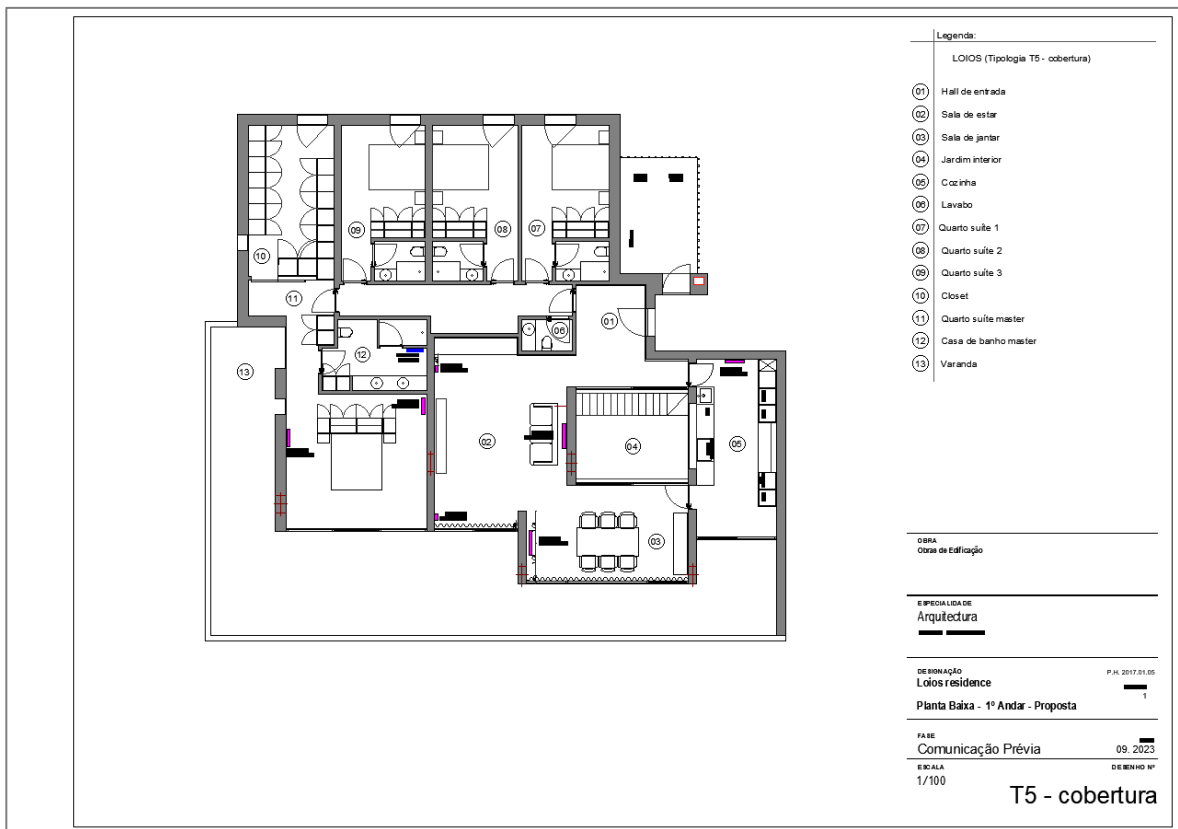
Planta baixa cedida pela construtora - Projeto CLM. Fonte: Acervo FBN.
